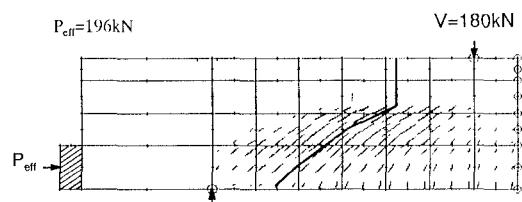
ひび割れ性状と抵抗断面（供試体PP-P）
